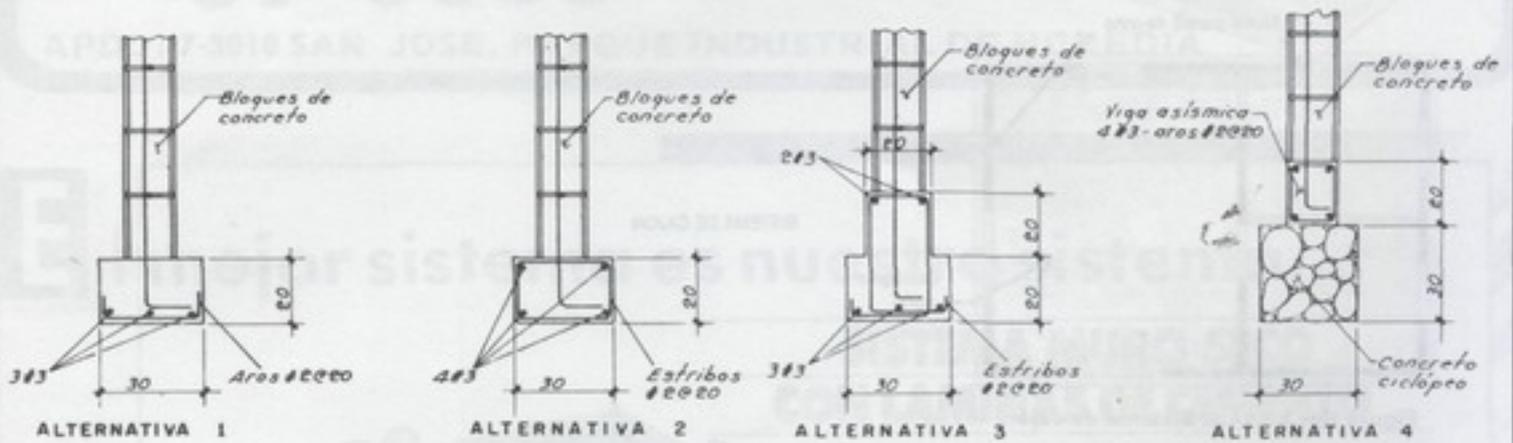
Detalle de vigas de fundación y asísmicas.
